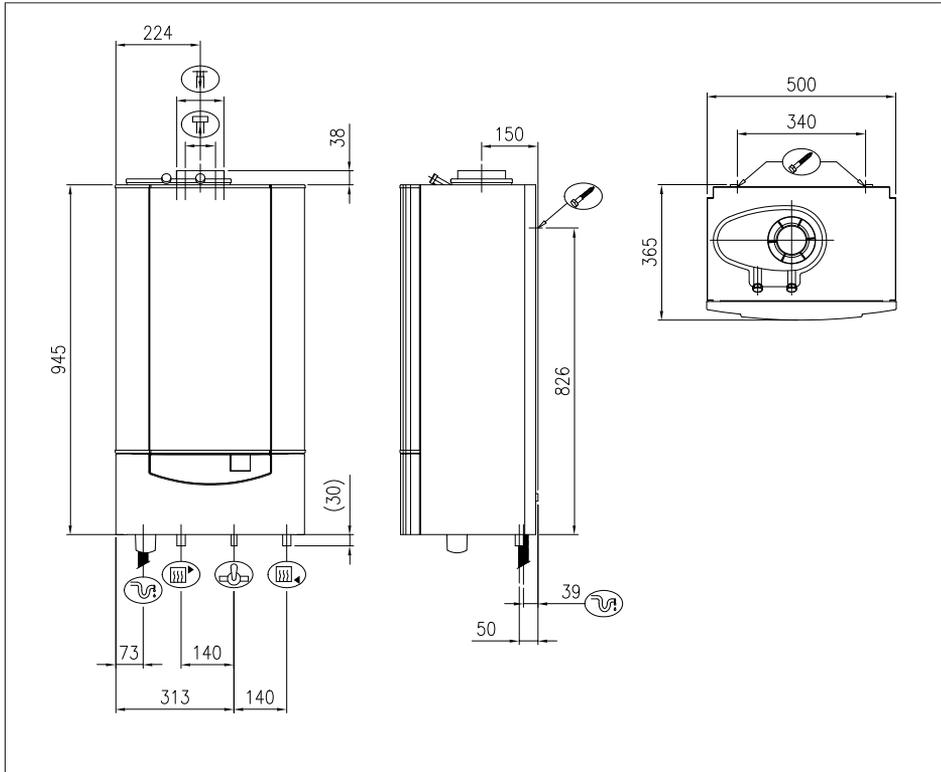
Dimensions Remeha Quinta 25s et Quinta 30s
